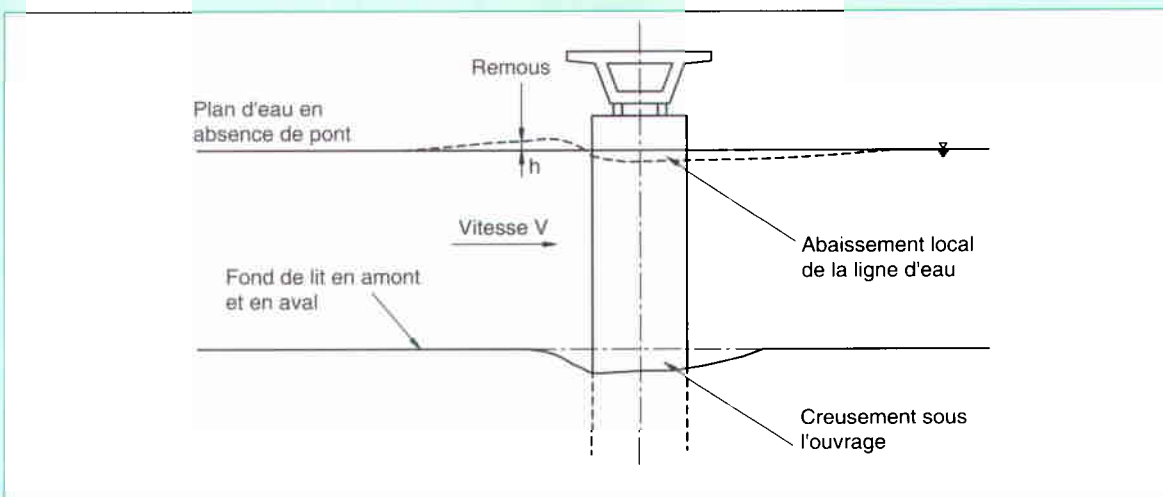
Remous d'exhaussement du plan d'eau en amont du pont.
